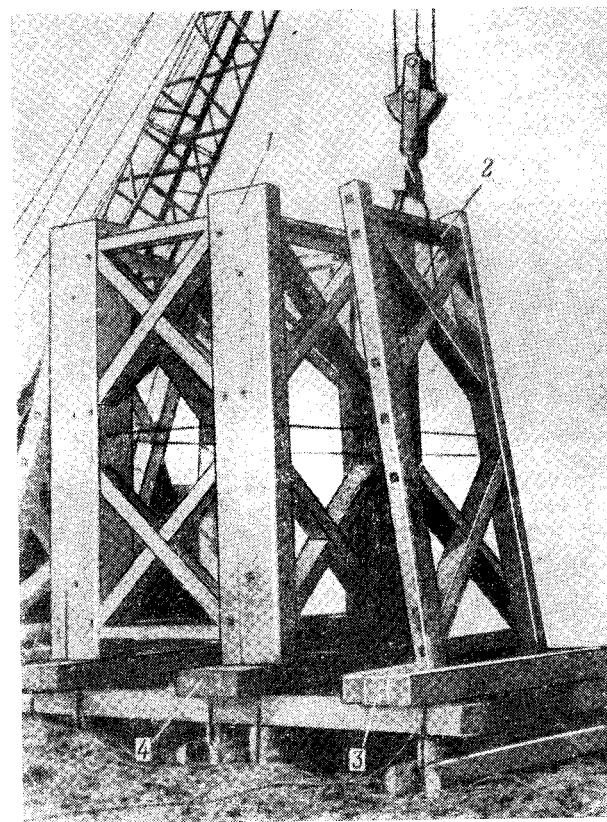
Монтаж деревянной блочной опоры высотой 4 м из брусев. Цифрами указаны номера блоков
